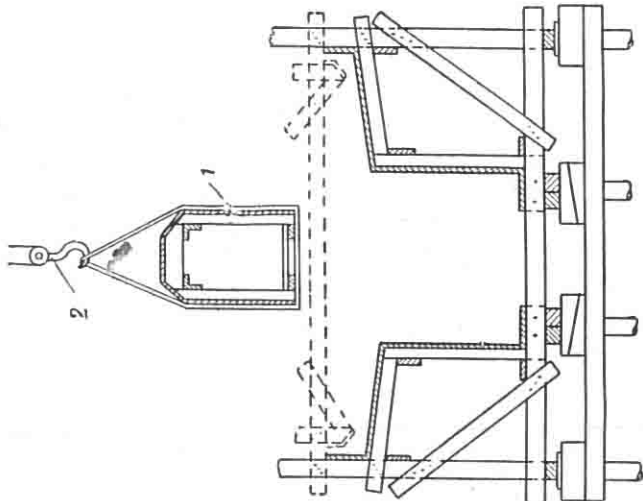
Конструкция внутренней части опалубки железобетонного пролетного строения в виде ко-
